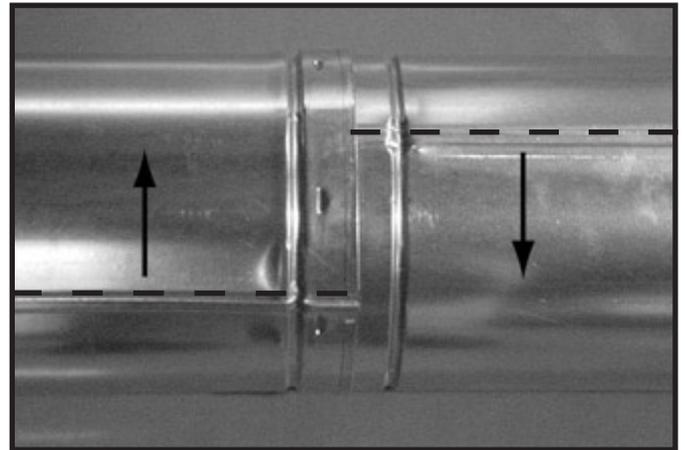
Faire pivoter les joints soudés pour démonter
